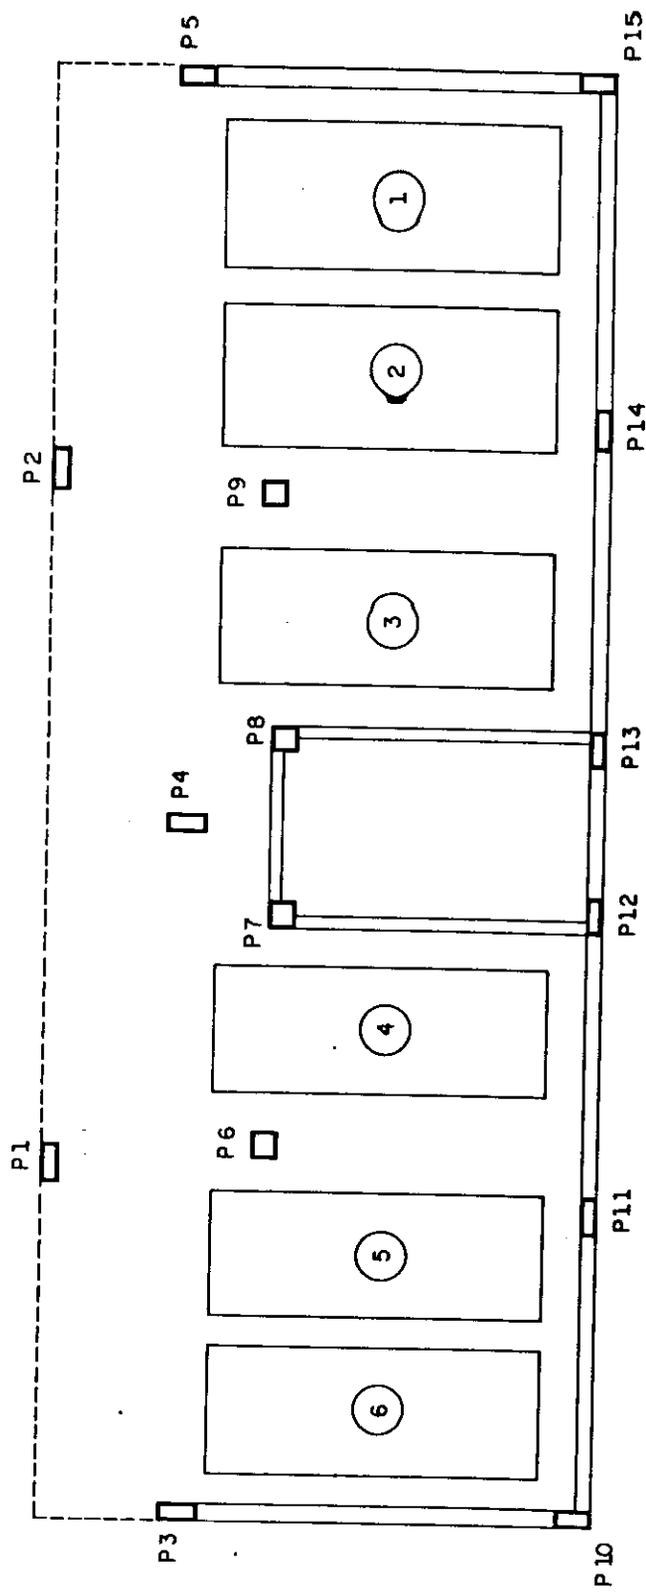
a - Estrutura III - Pavimento Tipo Edifício A
